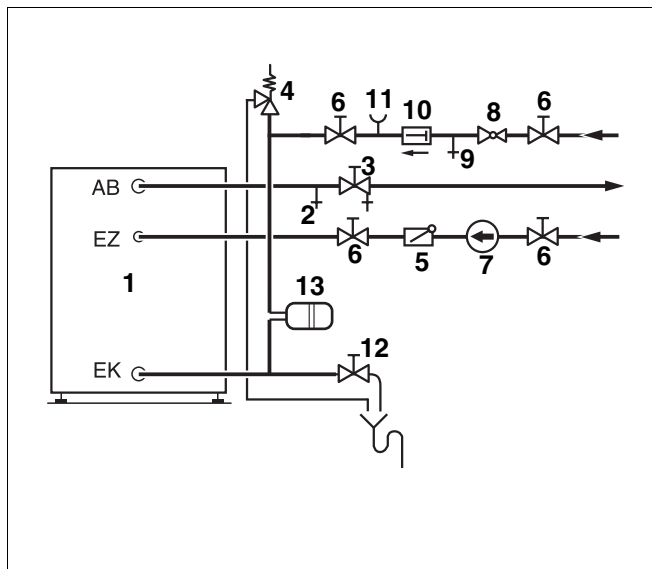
Installation côté eau chaude sanitaire (schéma de principe)
